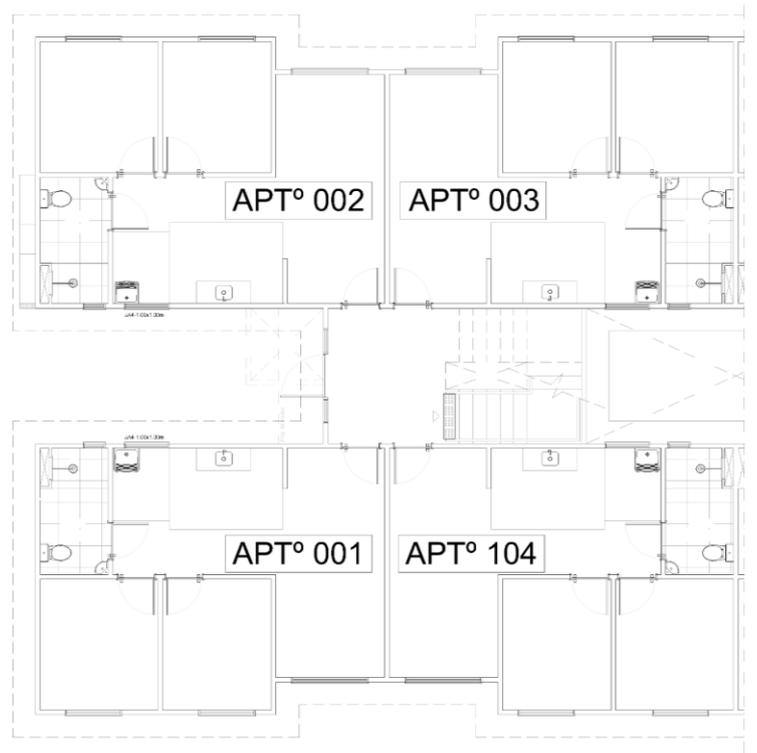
Lado A do bloco, uma escada e um hall atendendo 04 unidades habitacionais
